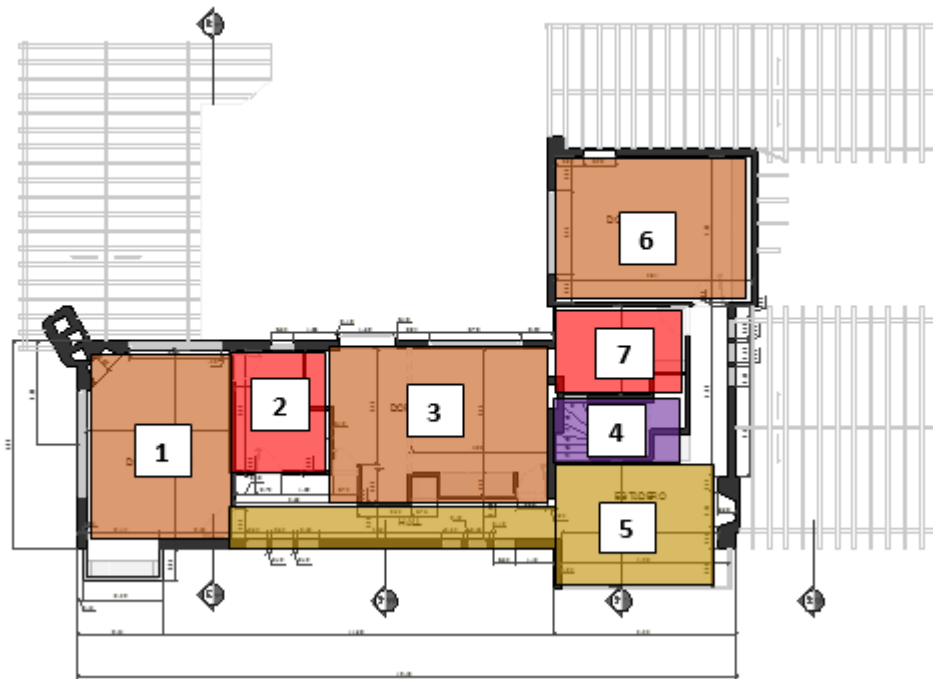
Plano distribución espacial segundo piso plano original Casa Correal 1962Figura 3-72: Plano distribución espacial intervenida primer piso
